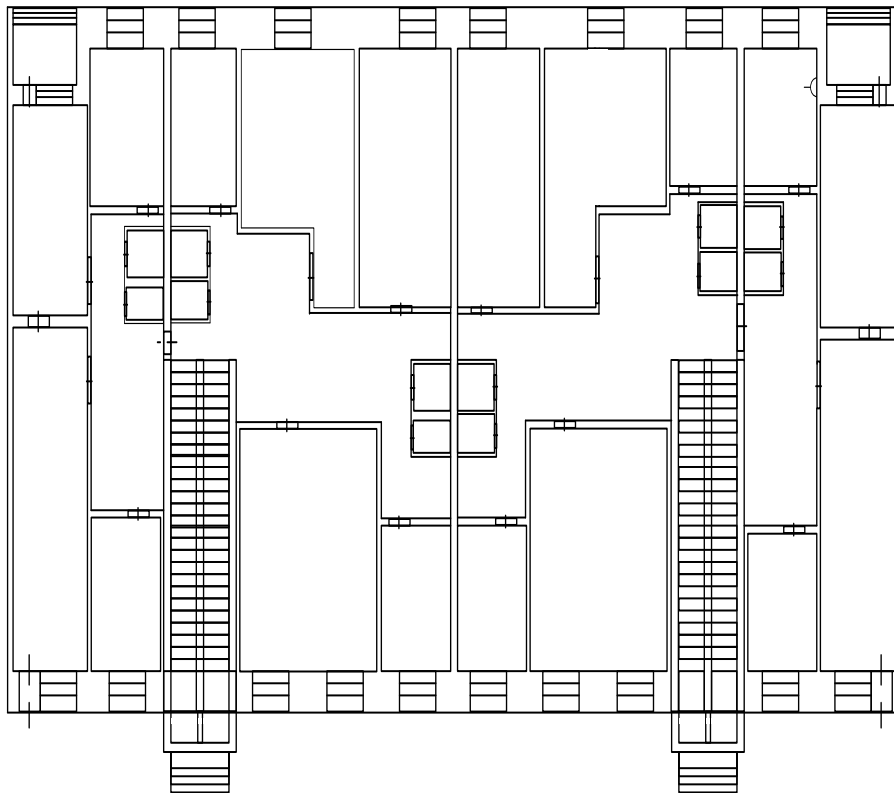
Будівельний план першого поверху житлового будинку
